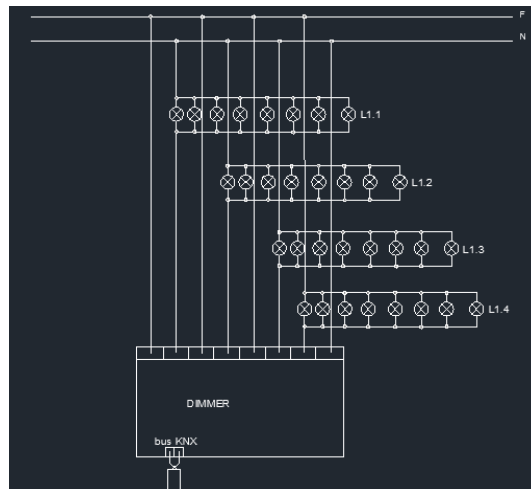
Conexión ejemplo dimmer alumbrado exterior zona 1
